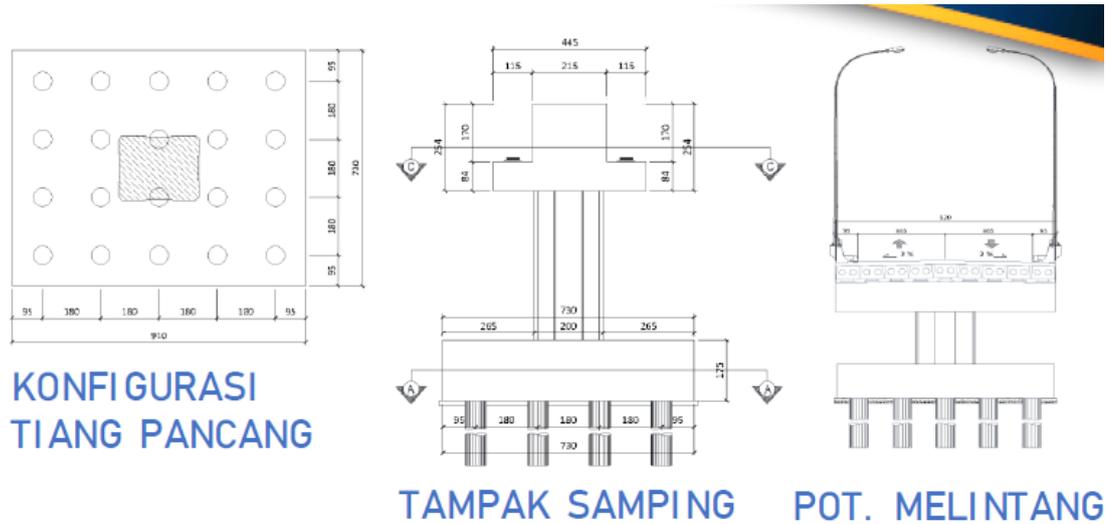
3 Gambar Ilustrasi Tipikal Struktur Pile Slab
